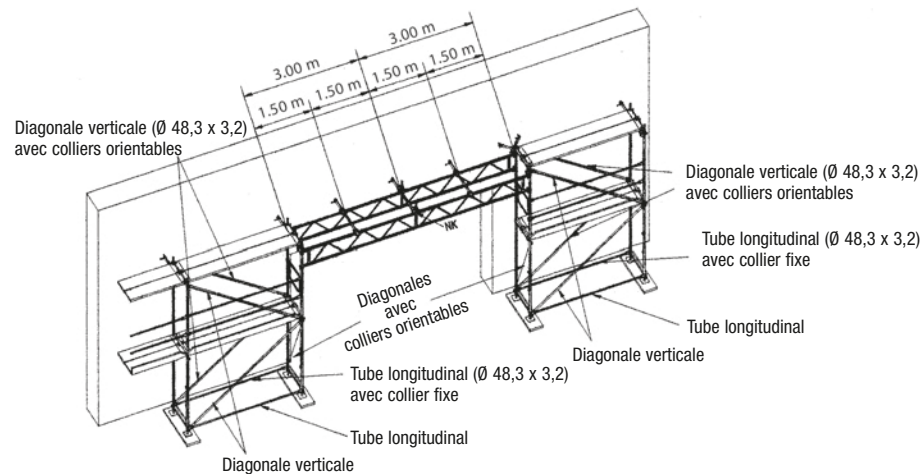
Renforcement de la membrure supérieur par ancrage dans la façade.
